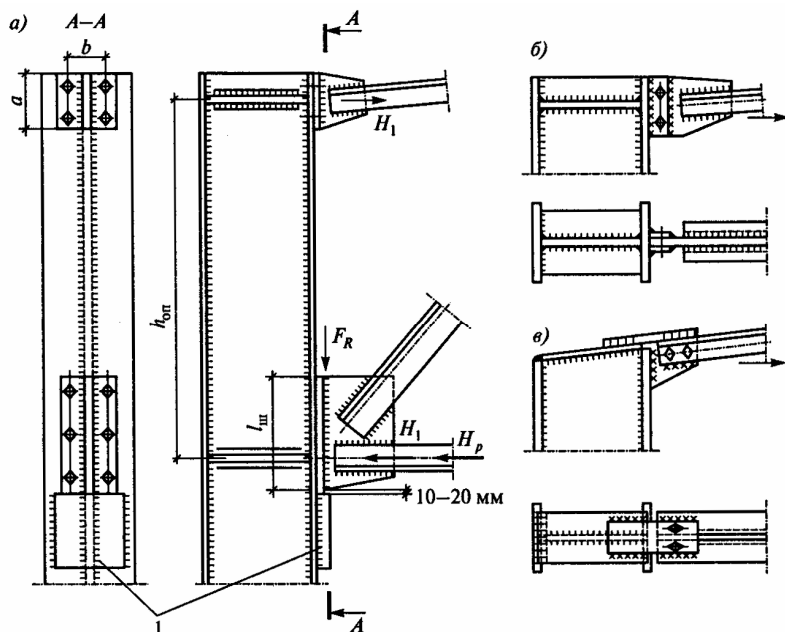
Вузол обпирання кроквяної ферми на колону збоку:
